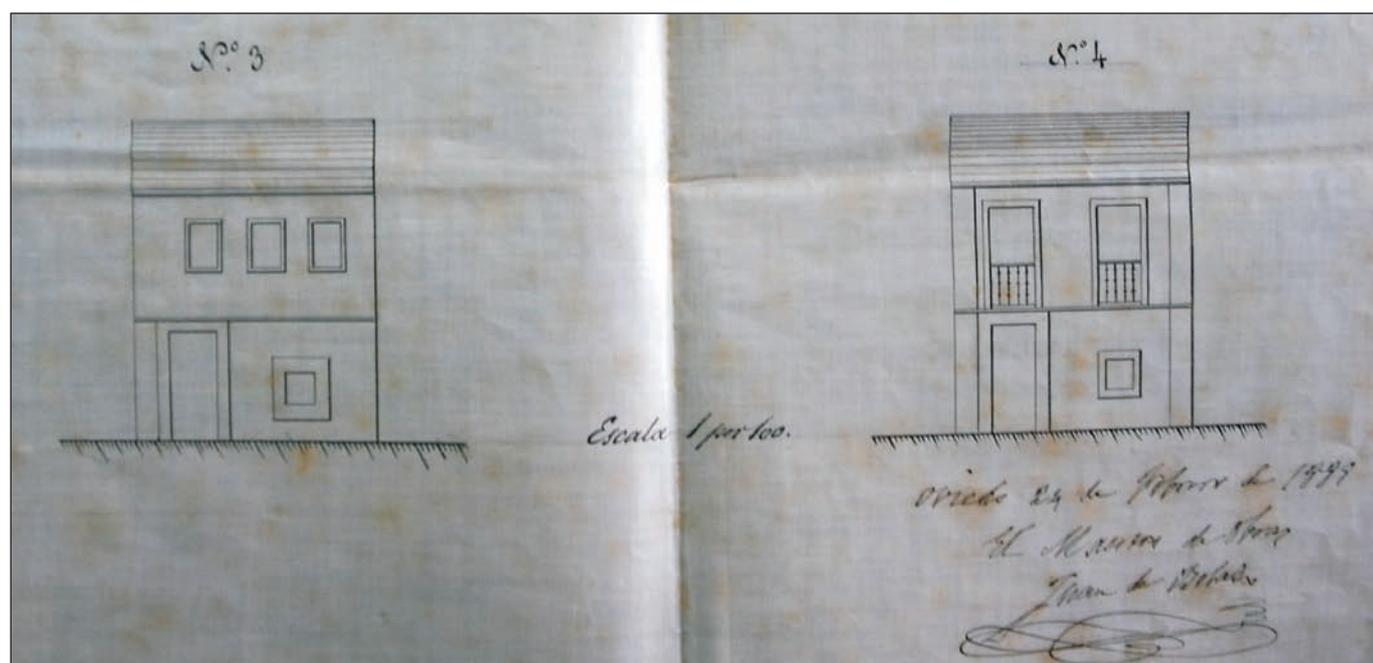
Alzado de una casa reformada en 1889 en el Carpio (A.M.O.) con la fachada original (nº 3) y su transformación (nº 4)
